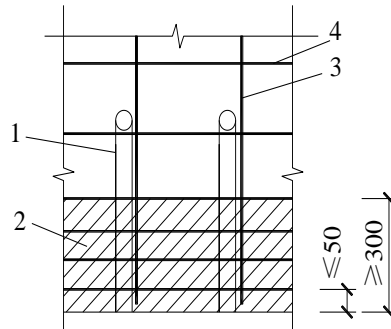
金属波纹管浆锚搭接连接部位水平分布钢筋的加密构造示意
